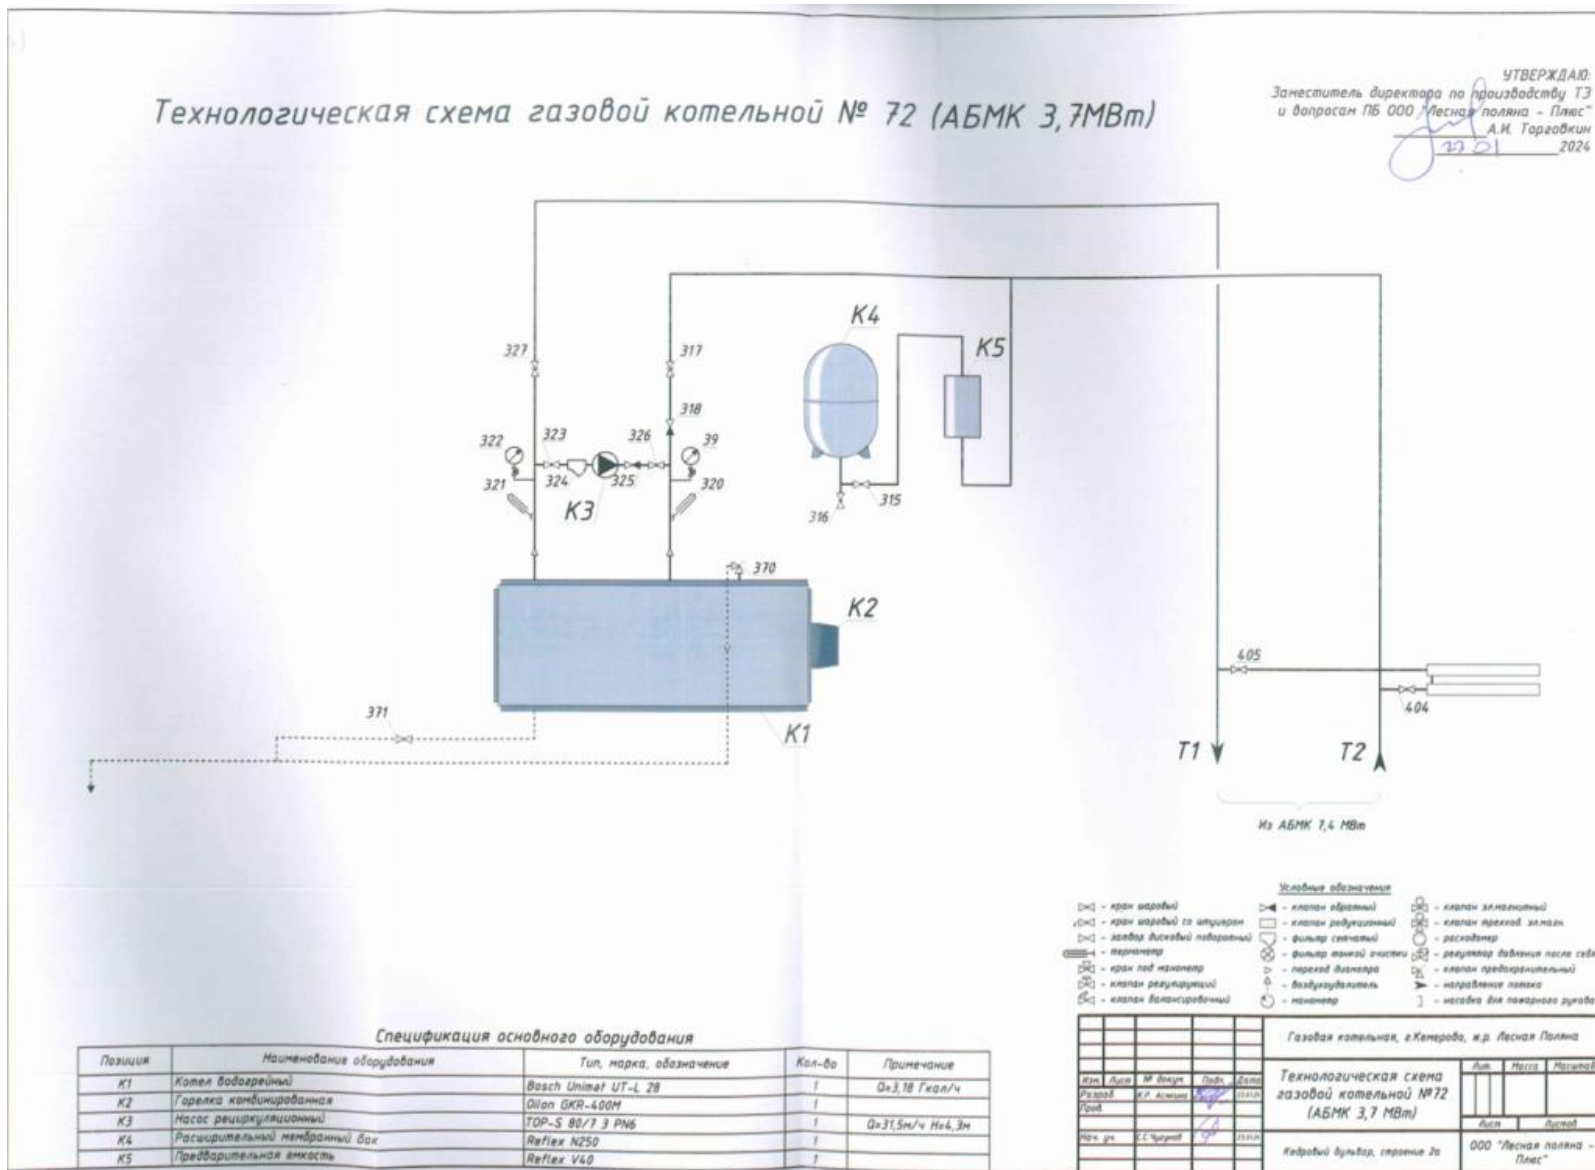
Тепловая схема Котельной № 72(1)
